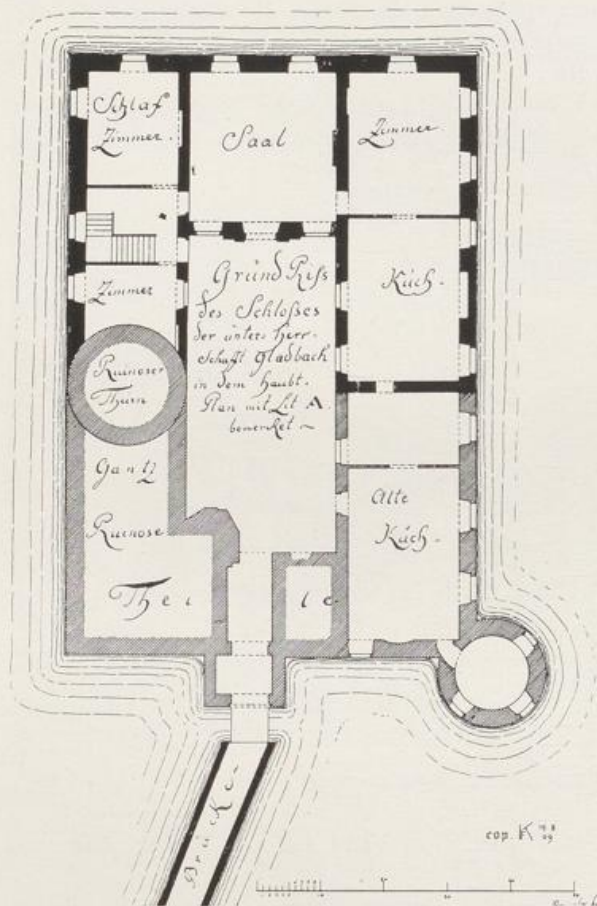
Burg Gladbach. Grundriss des Herrenhauses aus der 2. Hälfte des 18. Jh.
